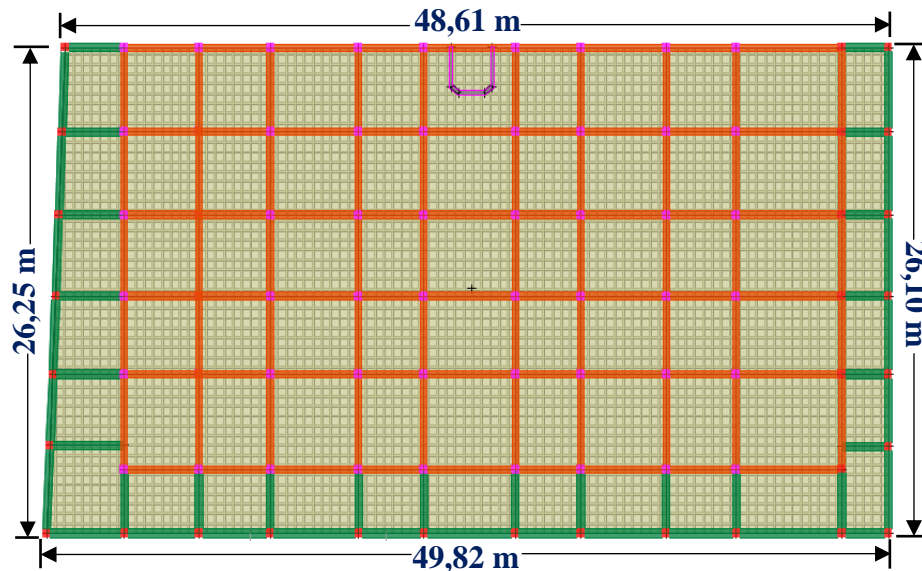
Bloques en planta para la estructura de hormigón armado.
